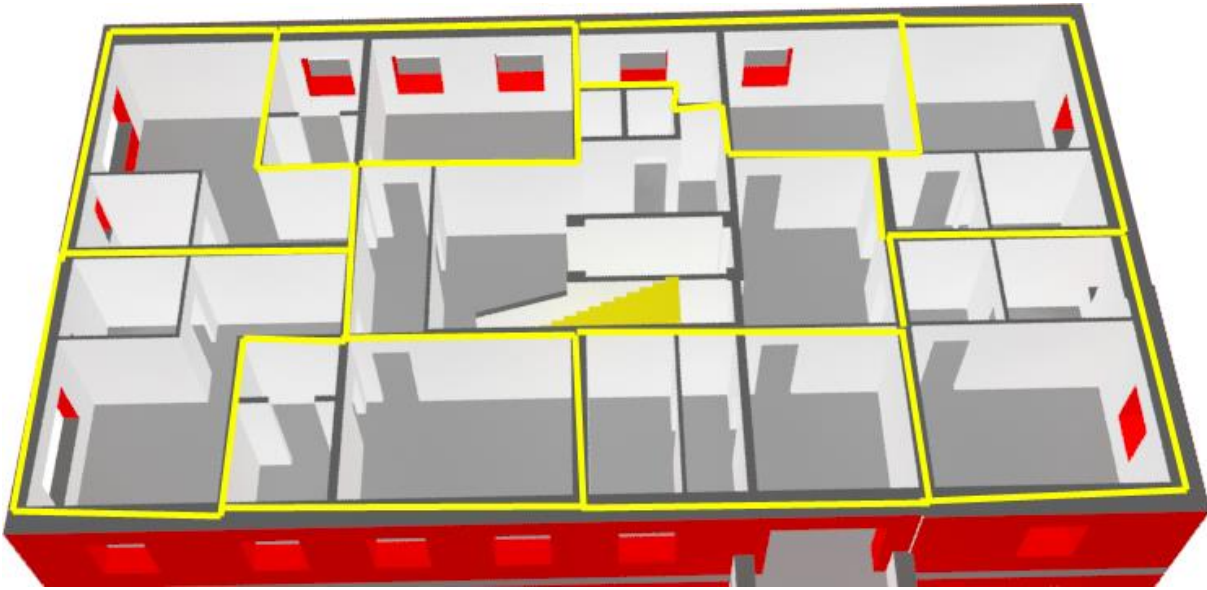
Planta primera (Fuente: Propia)
